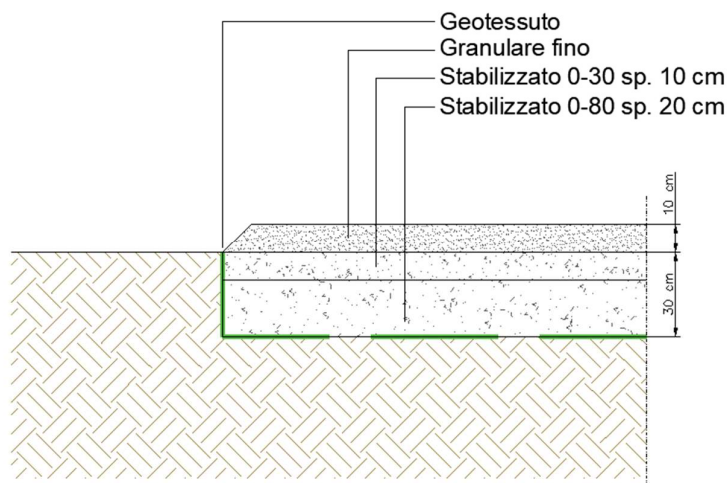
Sezione tipo viabilità interna all'impianto e piazzali
